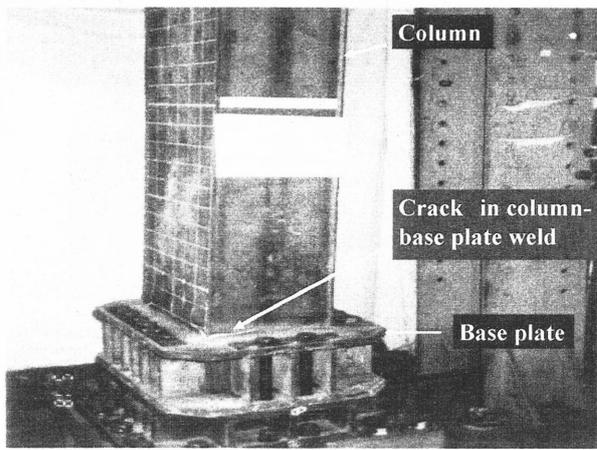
橋脚基部とベースプレート溶接部の割れ（実験）
